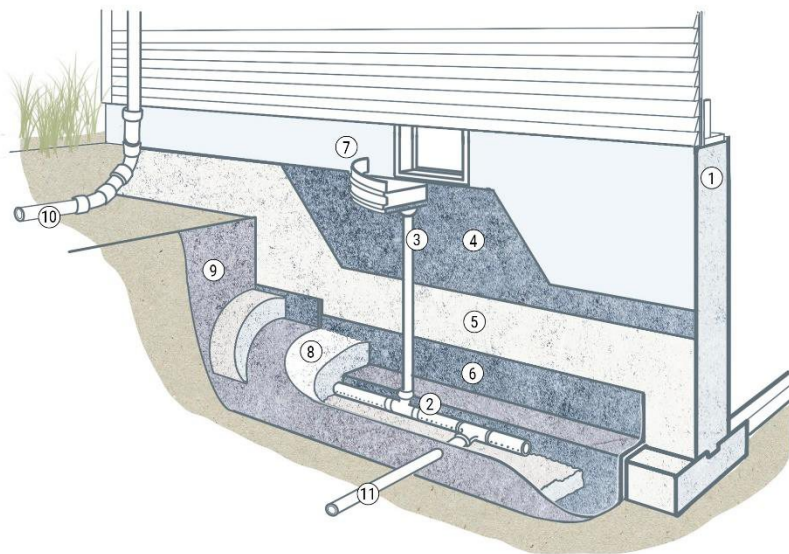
Schemă posibilă pentru drenaj perimetral clădirii și hidroizolare subsol. 1 - perete de subsol – din beton armat, dimensionat prin calcul structural și termoizolat conform normelor în vigoare; 2 - tub perimetral de drenaj cu diametru mai mare de 80 mm, prevăzut cu sistem de evacuare a apei către exterior; 3 - tubulatură de evacuare a apelor pluviale, conectată la sistemul de drenaj perimetral; 4 – hidroizolație; 5 - termoizolație din materiale rezistente la umiditate, protejată contra umidității prin metode specifice; 6 - strat de protecție împotriva colmatării – material geotextil; 7 - sistem prefabricat de protecție a ferestrei de subsol contra infiltrațiilor de apă, prevăzut cu sifon pentru evacuarea apelor meteorice; 8 - umplutură din pietriș grosier sau piatră spartă; 9 - umplutură de pietriș; 10 - sistem de evacuare pe teren a apelor pluviale de pe acoperișul clădirii; 11 - conductă de evacuare a apelor colectate de sistemul de drenaj către bazine de stocare sau către canalizarea orașului.
